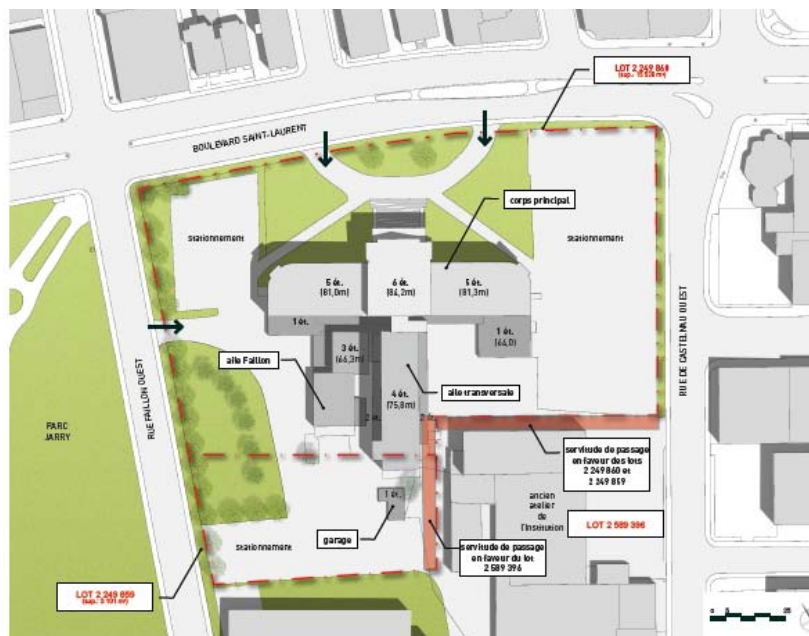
Plan des bâtiments du Centre 7400 (source : doc. 3.1, p. 4)
